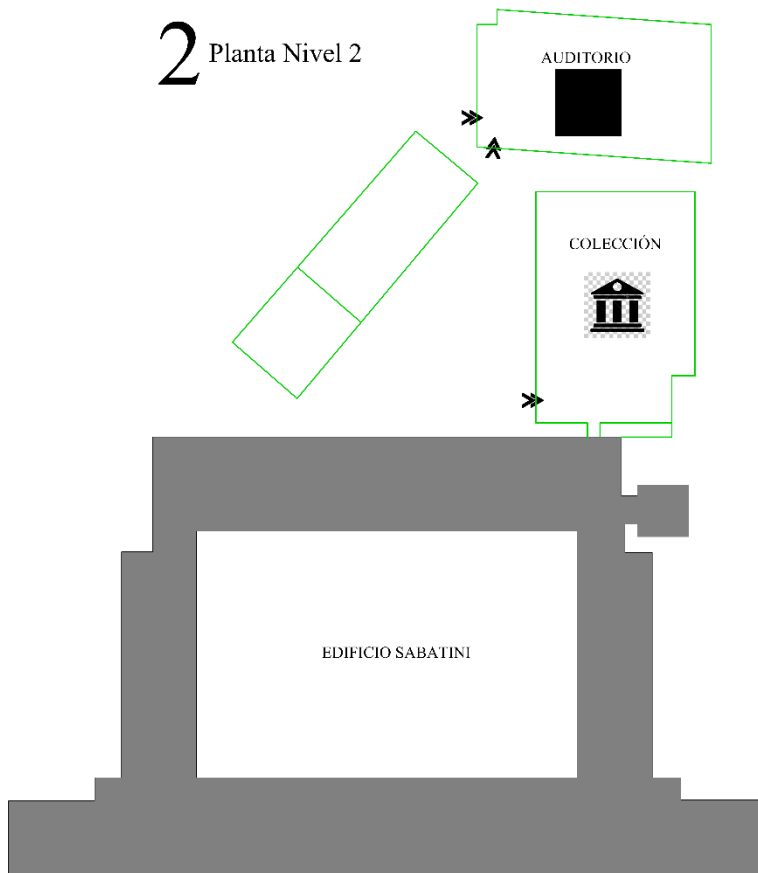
Planta Nivel 2, Museo Reina Sofía - Fuente: Elaboración Propia
